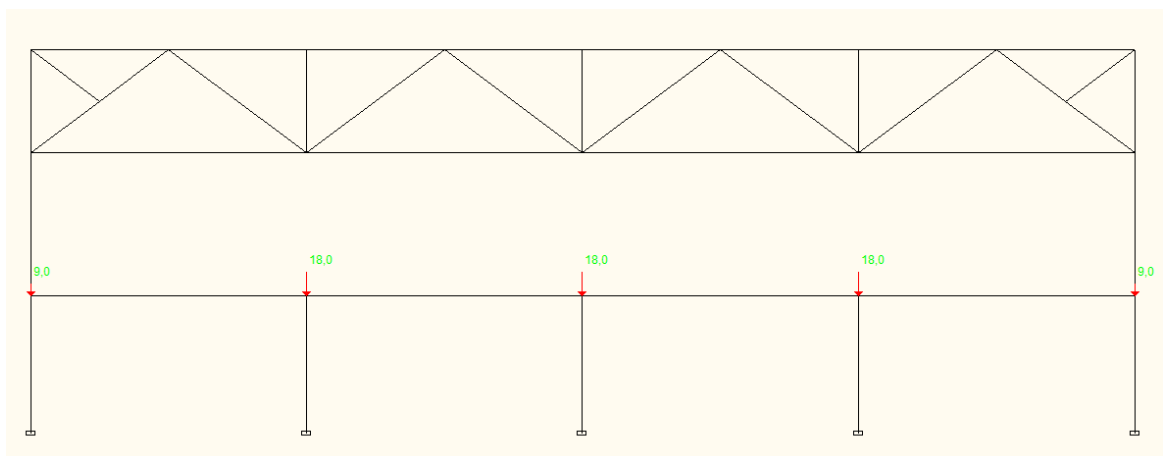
Схема приложения нагрузки на перекрытие рамы
